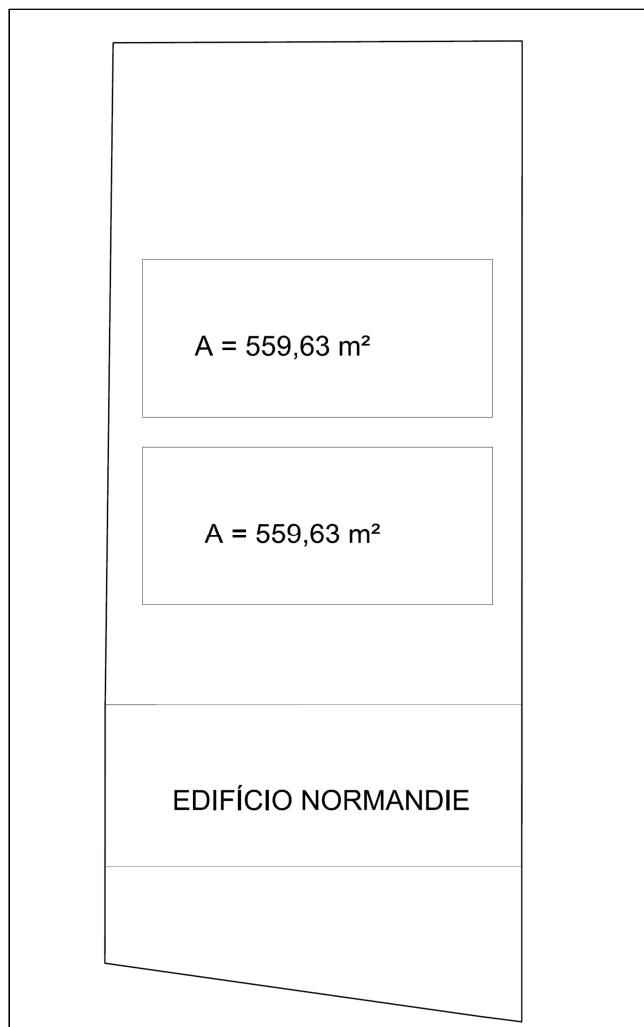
Planta do lote conforme proposta do SEPHAN/IPUF, considerando uma área total de 3.964m² e os dois blocos liberados para construção com uma área total por pavimento de 559,63m², distantes 10 metros do edifício Normandie, e 06 metros de afastamento entre si. Considerado afastamento lateral mínimo de ambos os lados - 3 metros – conforme legislação vigente.
